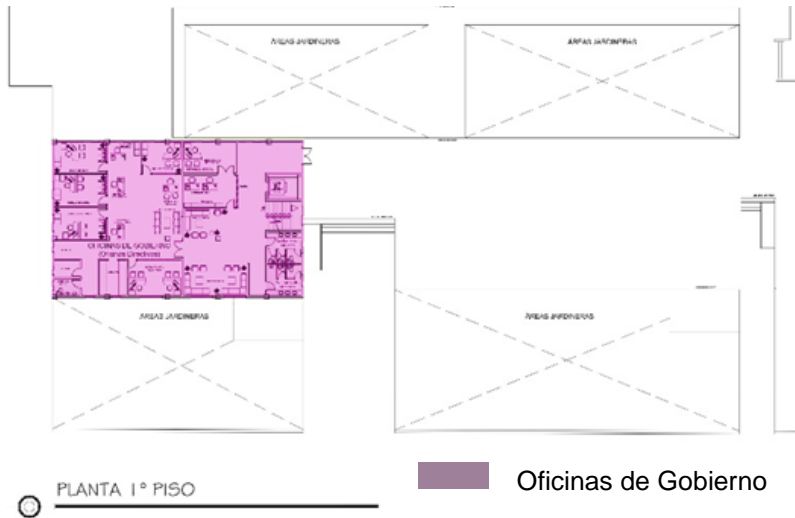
Proyecto Arquitectónico Planta 1° Piso
